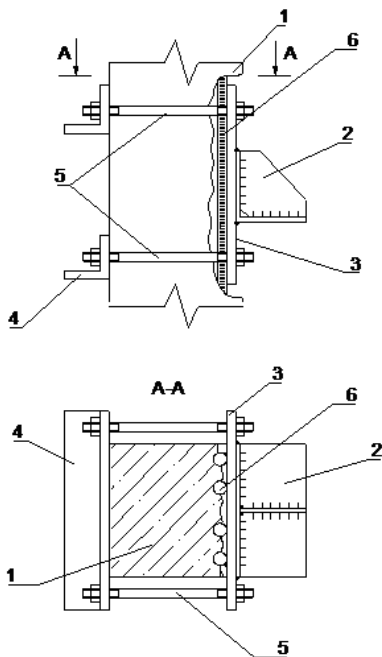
Крепление опорных столиков к колоннам для опирания стеновых панелей: 1-колонна; 2-опорный столик из уголка с ребром жесткости; 3-пластина с отверстиями для болтов; 4-анкерный уголок-шайба; 5-стяжные болты; 6-обнаженная арматура колонны (после приварки пластины зачеканить цементно-песчаным раствором).
